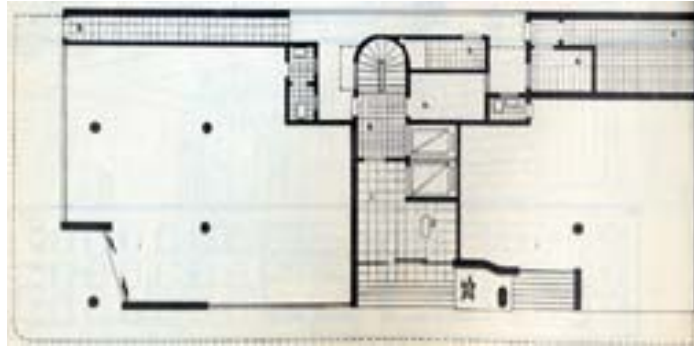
Planta baixa térreo, publicada na revista Espaço-Arquitetura, nº1.
